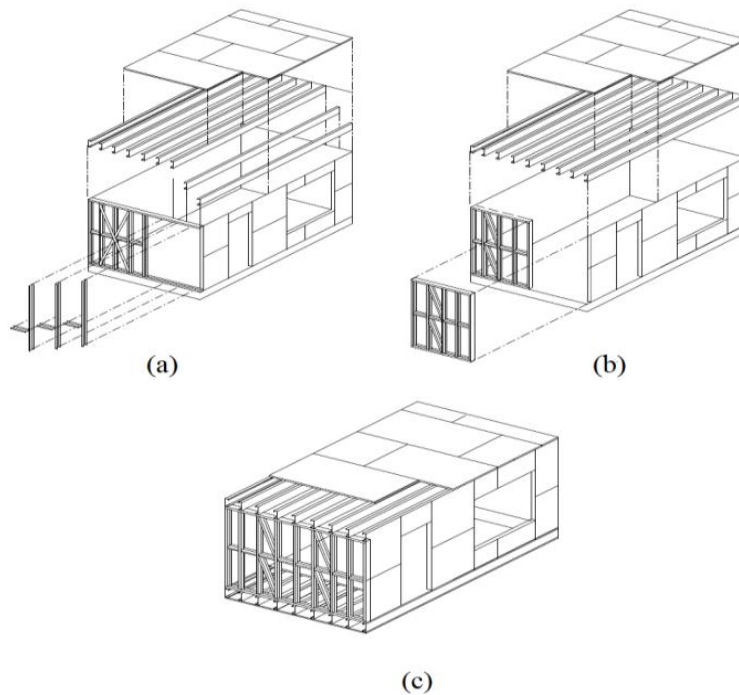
Métodos construtivos em L.S.F.: (a) construção tradicional; (b) construção por painéis; (c) construção modular
